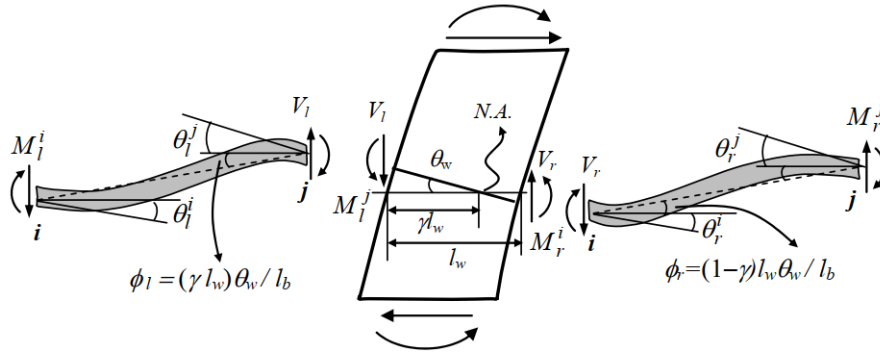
Configuración deformada de un muro conectado por dos vigas [75].
